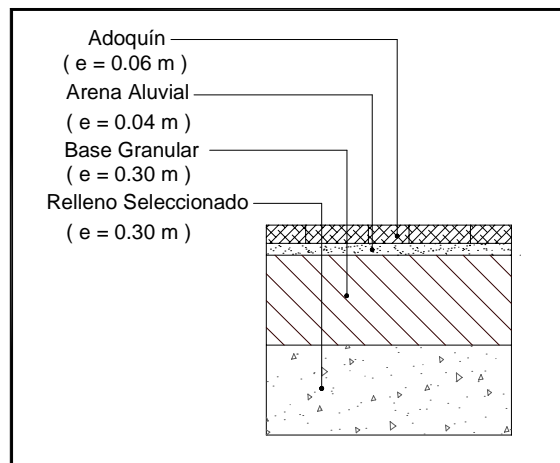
Esquema de Estructura de Pavimento – Zona de Adoquinados
